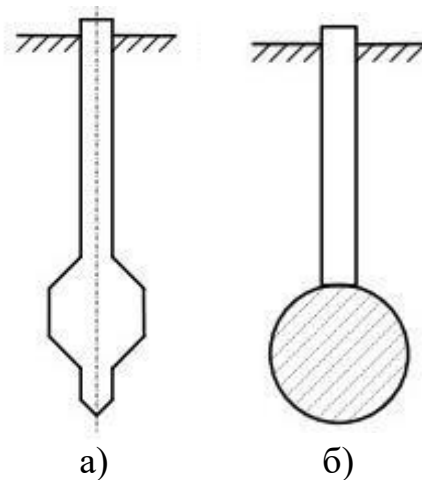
За конструкцією нижнього кінця: а – палі з механічним розширенням; б – палі з камуфлетною п’ятою
